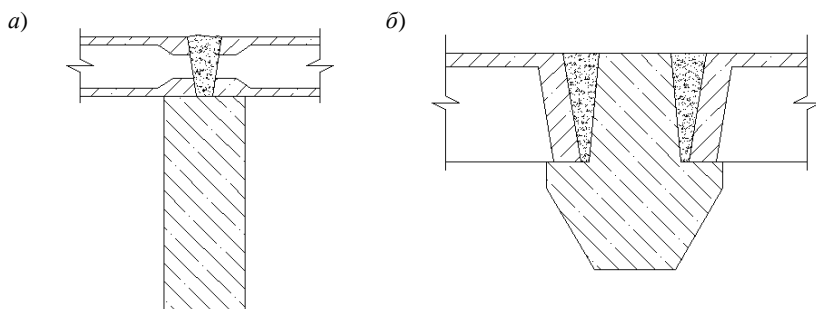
Опирание плит перекрытий на ригель:
